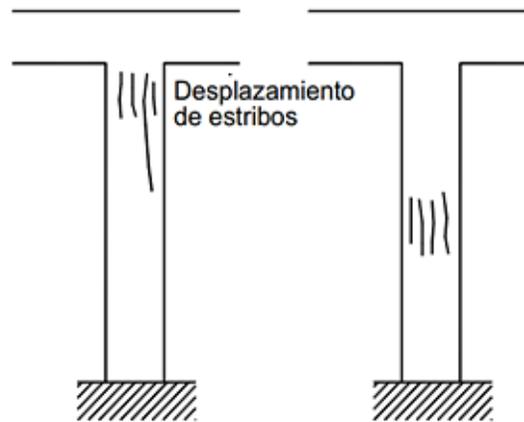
Fisuración por compresión en columnas (Pérez, 1994).
